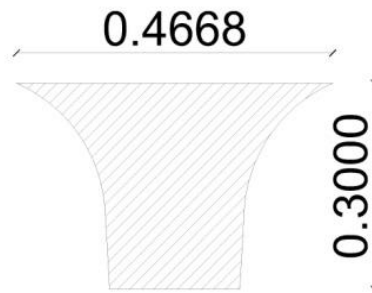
Schema Piastra d'unione della trave reticolare
